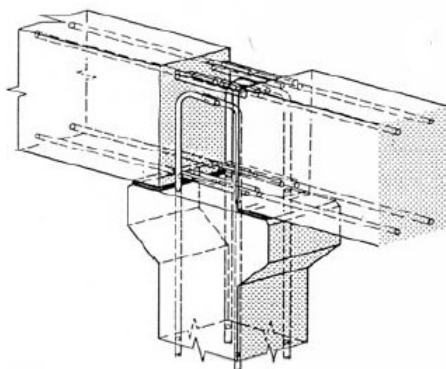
Modelo de ligação entre pilar – viga com betonagem local do nó.
